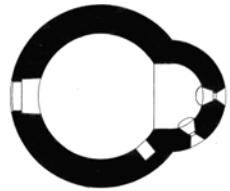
Grundrisse Rechberg (DM 4,82 m), M1:200. BDA Planarchiv Wien/Wolfsgruber.
